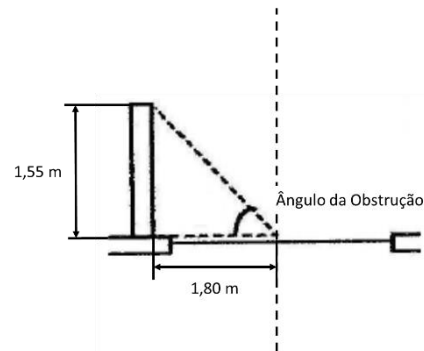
Ângulo de Obstrução do Elemento Vertical Adjacente ao Envidraçado do Piso 2 do Longo Bloco com Gabinetes
